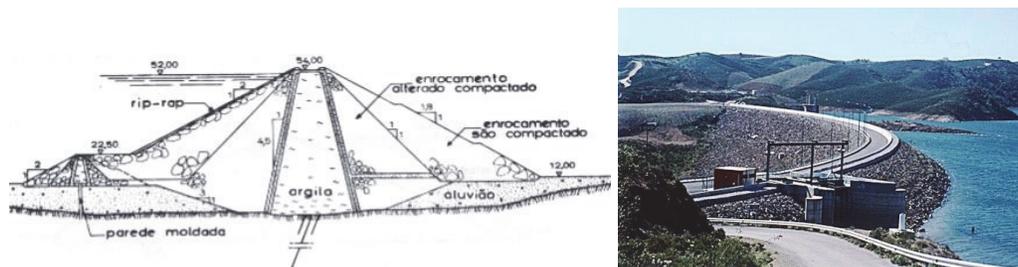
Corte transversal central e vista aérea da barragem de Beliche.
